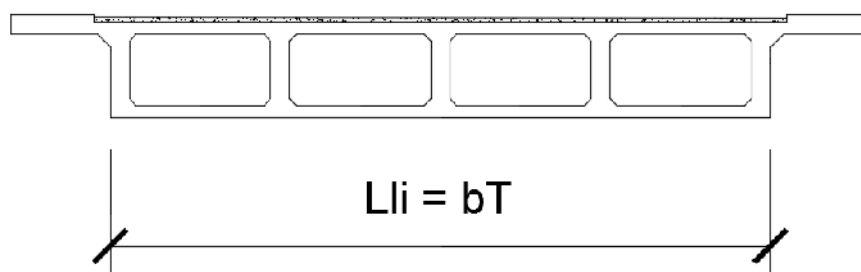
Detalle de longitudes del puente utilizadas para el cálculo. (Fuente: elaboración propia)
